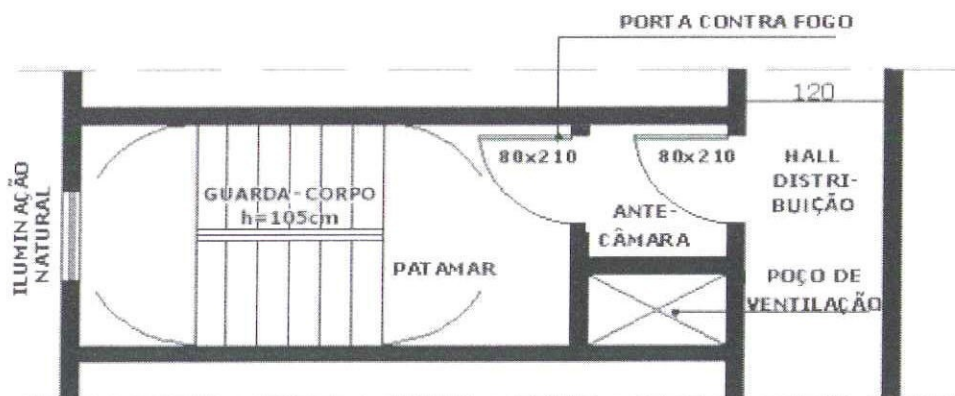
Detalhe escada para edifícios com mais de 9 pavimentos
